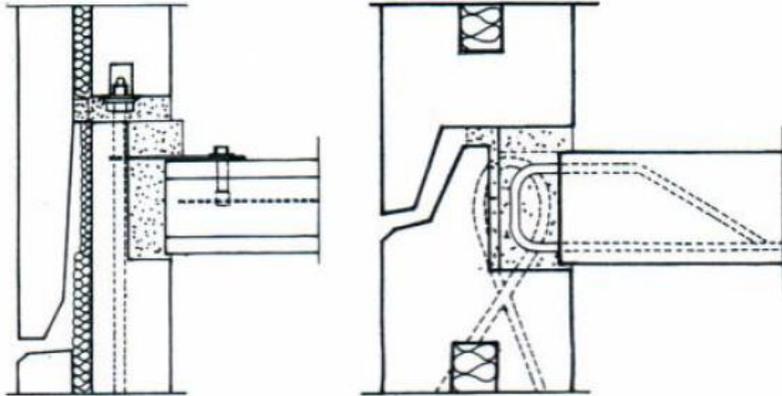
Unión química entre paneles prefabricados de hormigón y forjados.
